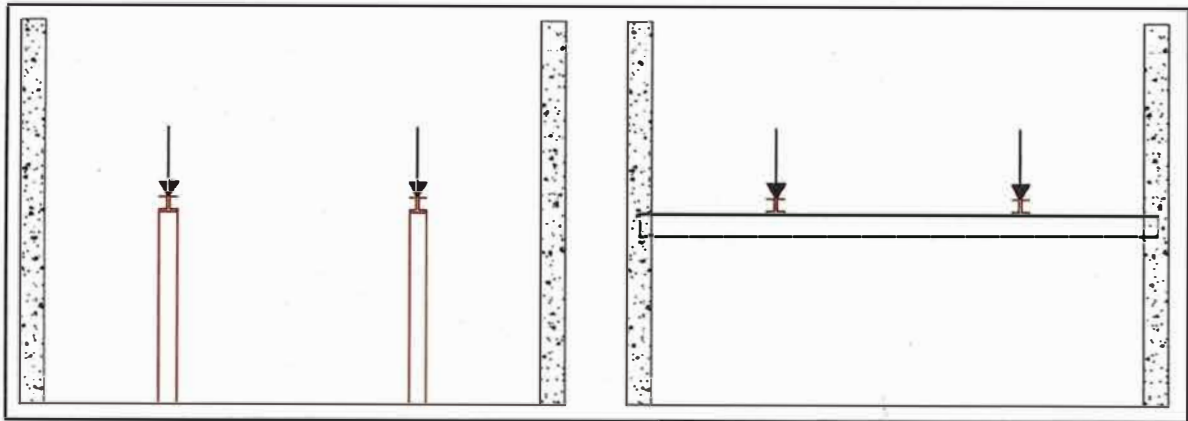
Calzadura, supresión de columnas y colocación de una viga de soporte.
